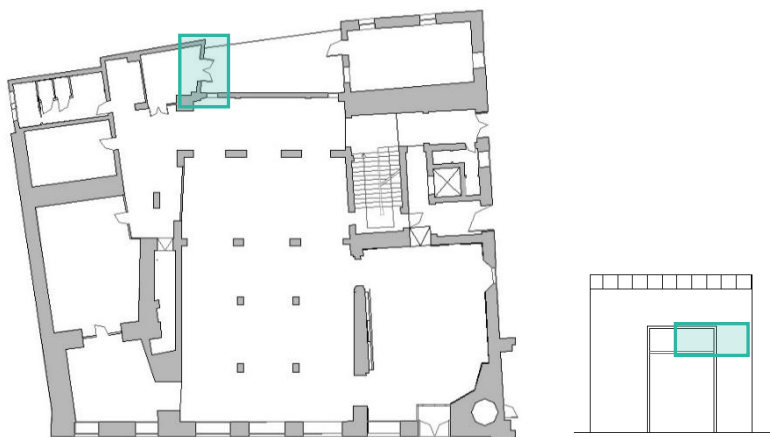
Individuazione macroelemento, pianta e prospetto
